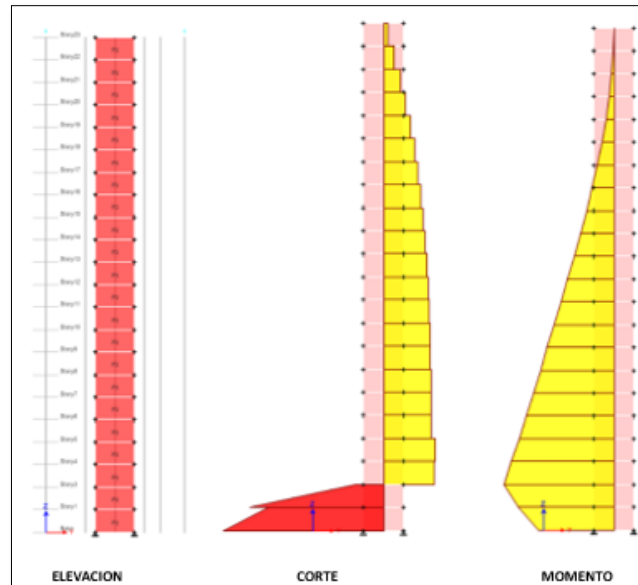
Detalle Elevación y Esfuerzos en Muros
